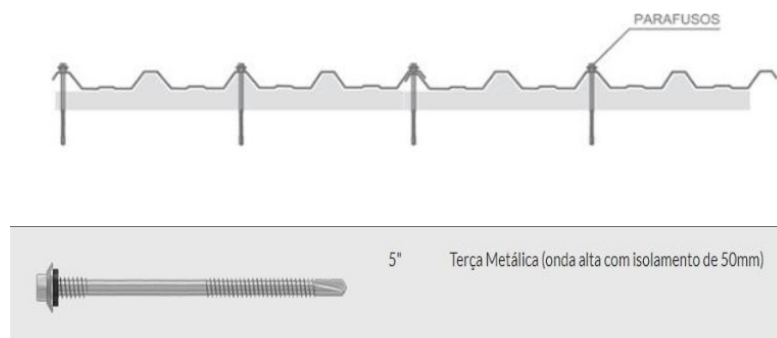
Fixação da Telha Trapezoidal Termoacústica
